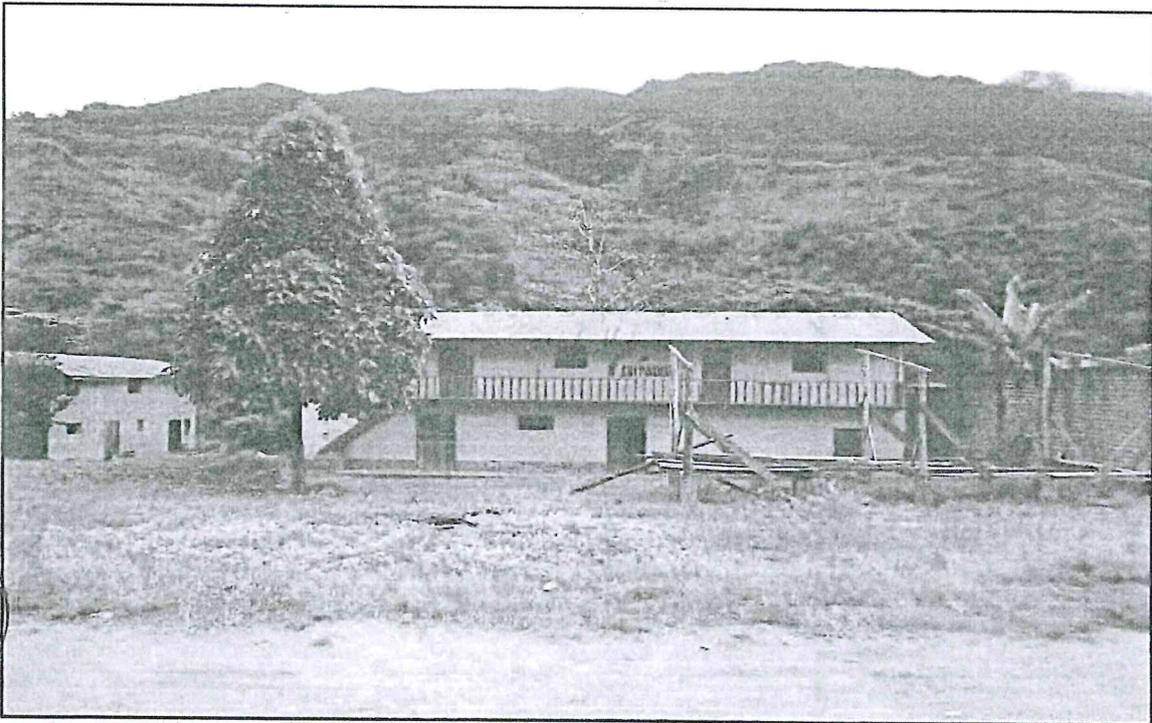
Viviendas principalmente construidas de materiales de madera sin una adecuada técnica constructiva
